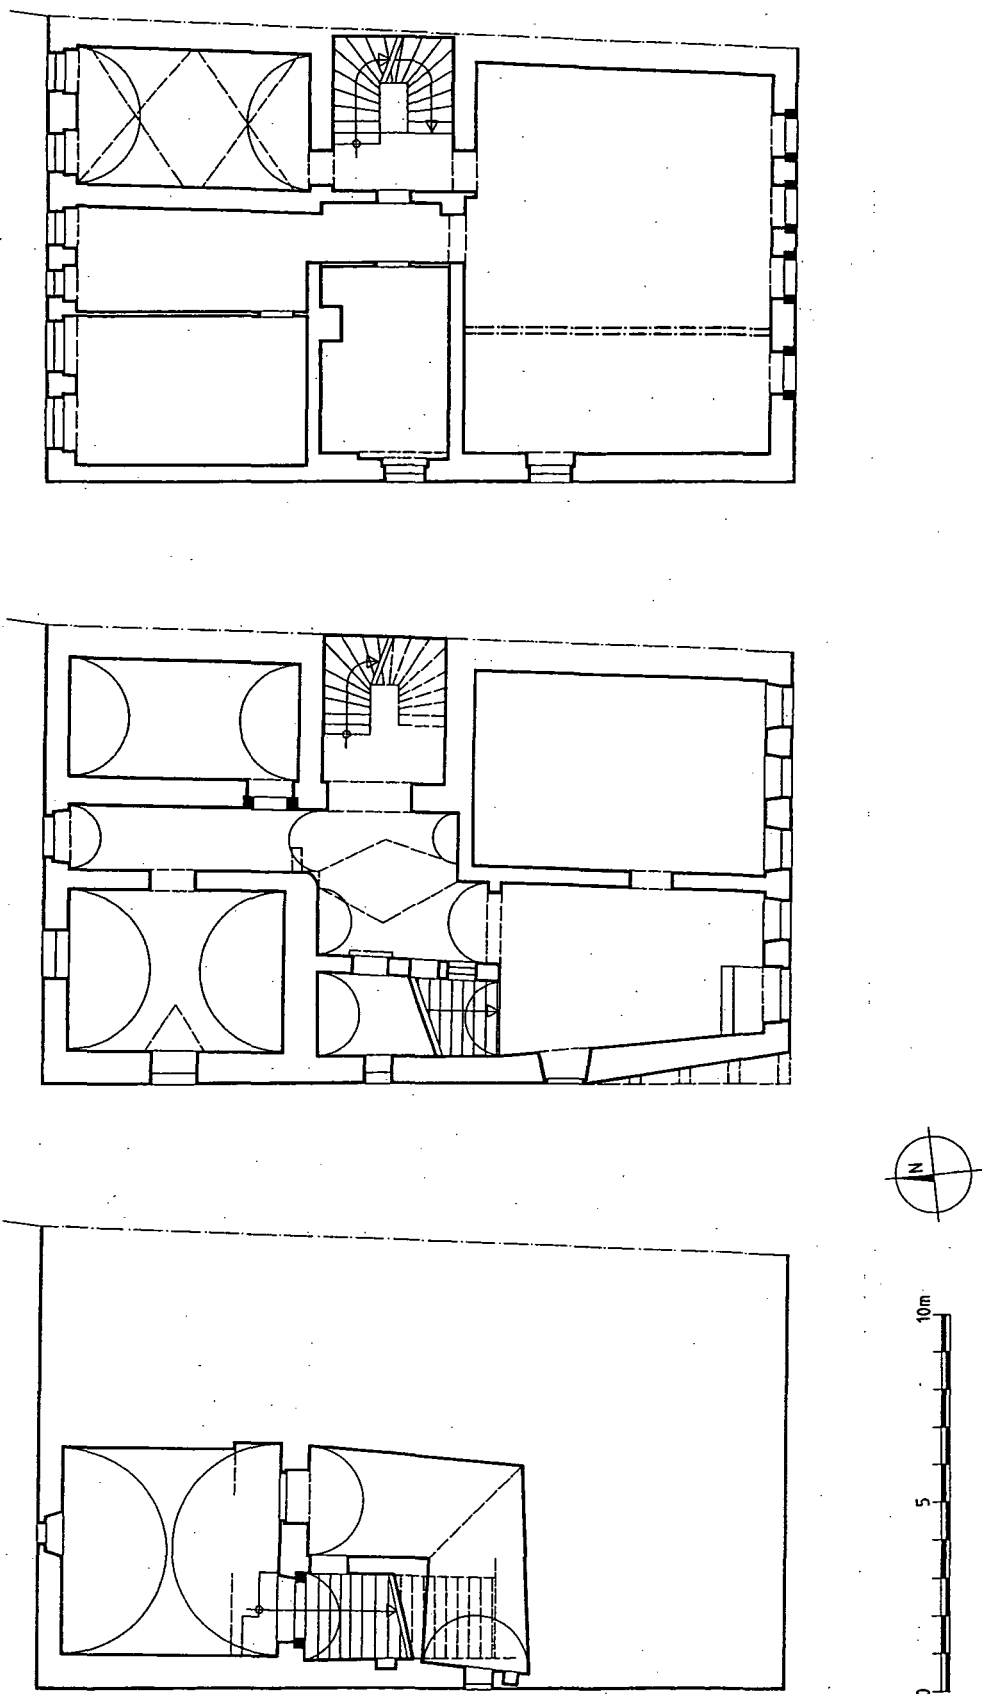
Schmiedstraße 26 – Grundrisse Keller, Erdgeschoss, Obergeschoss (1:200).
